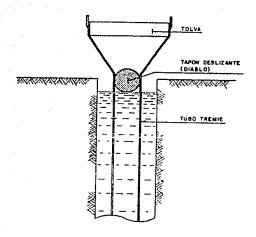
COLOCACION DE TAPON DESLIZANTE O DIABLO EN LA TUBERIA TREMIE.
